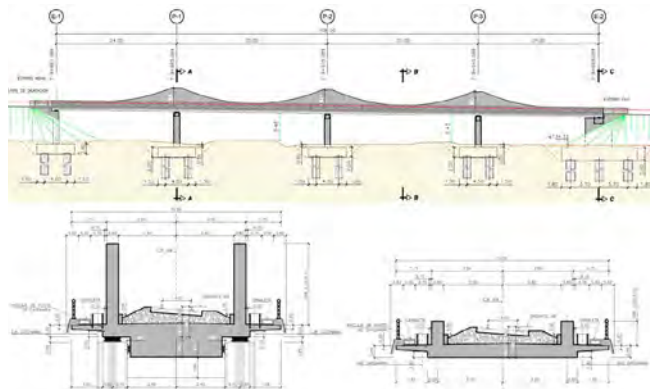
Viaducto sobre la carretera N-347. Alzado longitudinal y secciones tipo.
